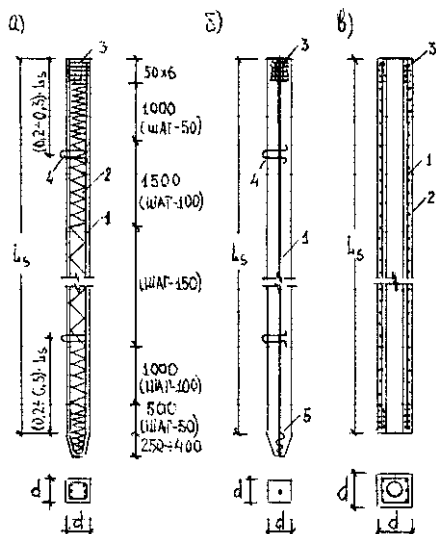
Армирование железобетонной призматической сваи: а – с поперечным армированием ствола, б – без поперечного армирования ствола, в – с круглой полостью
